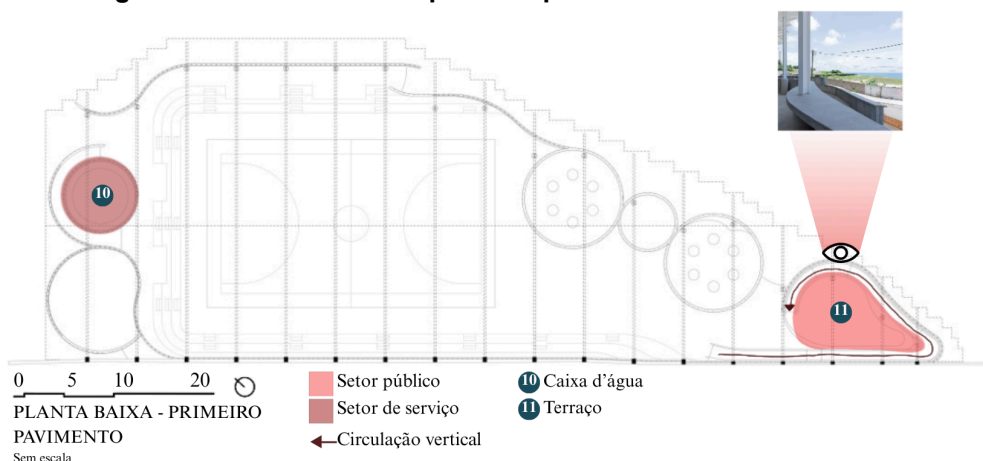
Planta baixa do térreo pavimento da Arena do Morro
